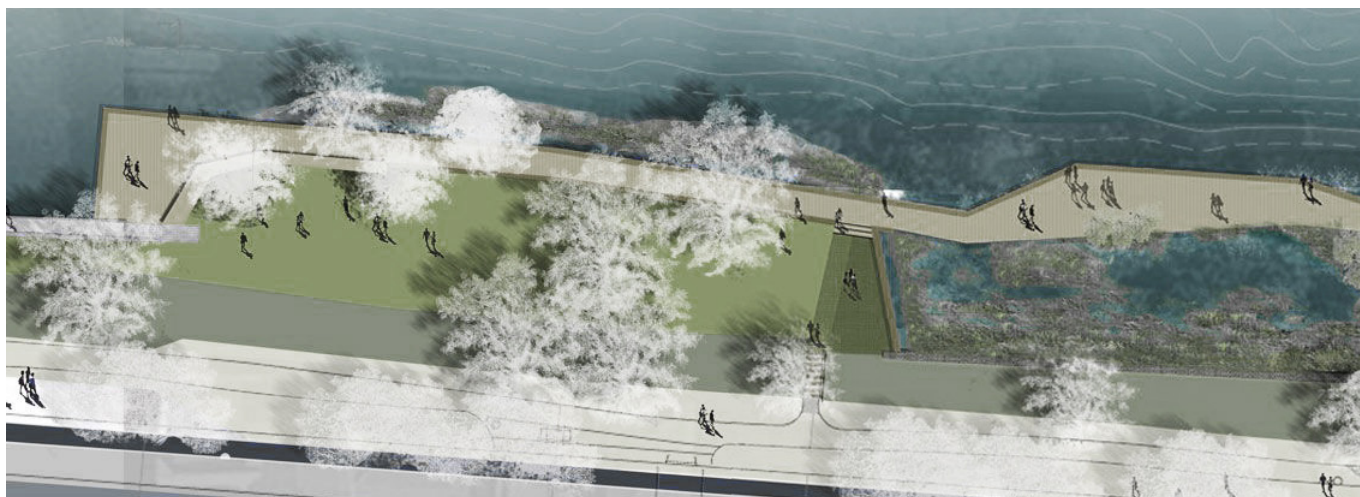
Continuação da planta baixa da área de decks e piers.
